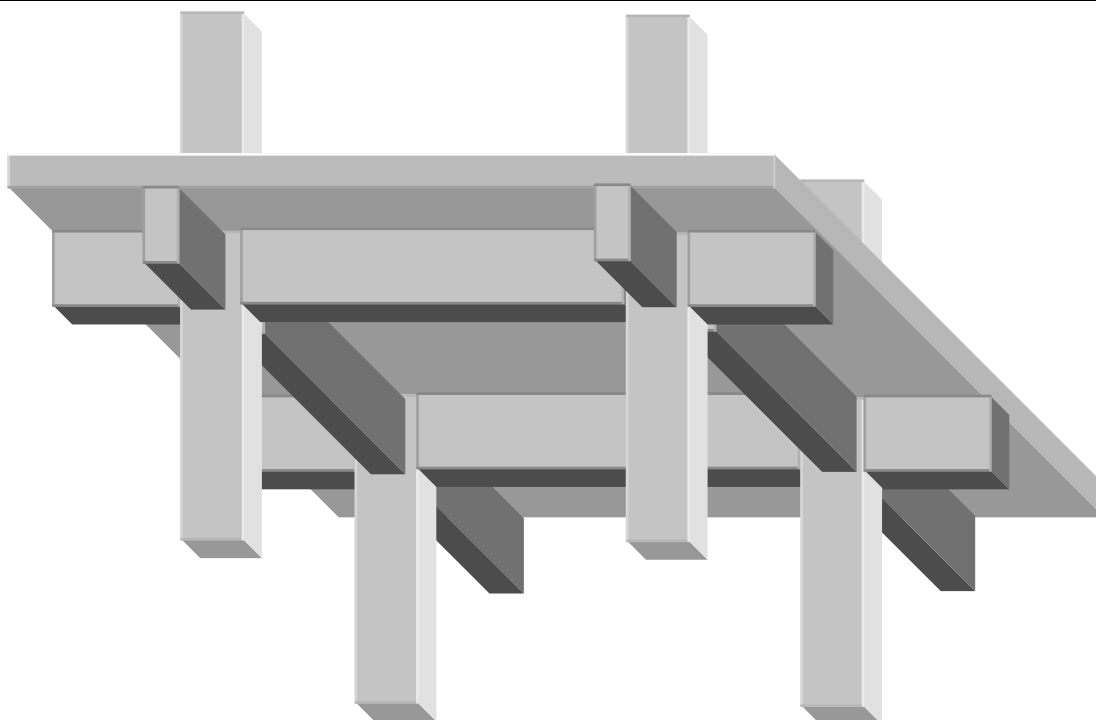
Sistema estrutural convencional laje armada em duas direções (“two-way slab”).
